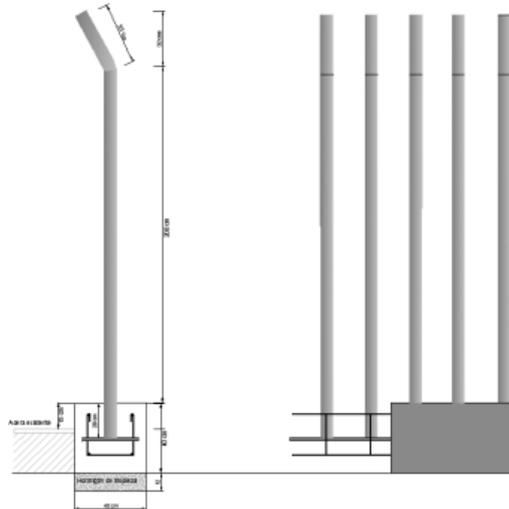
Cerramiento de la planta con valla tipo expo
